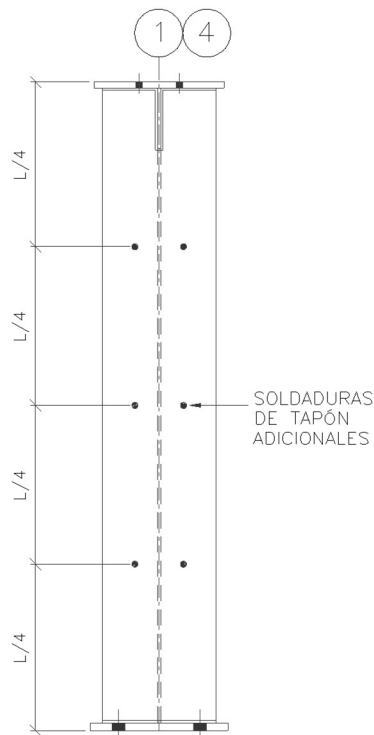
Detalle de soldaduras adicionales en láminas (archivo propio)
